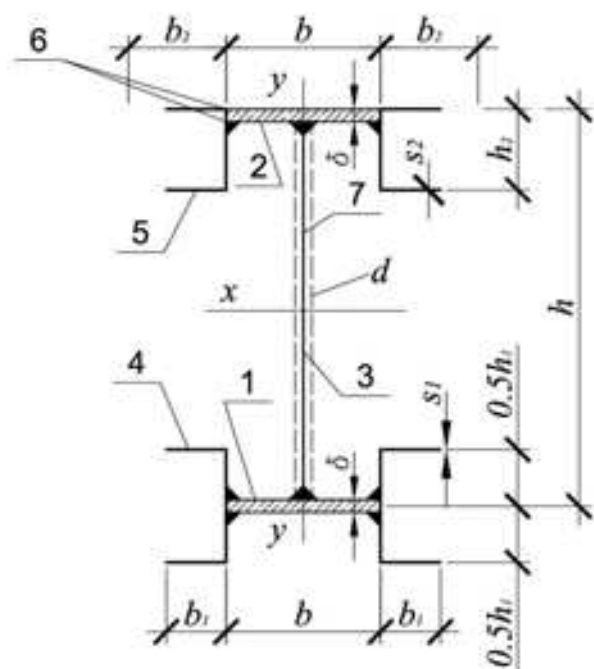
Сварной двутавр стальной балки, полки которого оборудованы гнутыми стальными швеллерами – элементы каркаса термоизоляционного пояса (обогрев поперечного сечения стальной балки с трех граней): 1 – растянутая полка; 2 – сжатая полка; 3 – гофрированная стенка; 4 – швеллеры растянутой полки; 5 – швеллеры сжатой полки; 6 – сварной шов; 7 – антикоррозионное покрытие сварного двутавра;  $h_1 \times b_1 \times s_1$  – высота, ширина и толщина гнутого швеллера, прикрепленного к растянутой полке сварного двутавра стальной балки;  $h_2 \times b_2 \times s_2$  – высота, ширина и толщина гнутого швеллера, прикрепленного к сжатой полке сварного двутавра стальной балки;  $d$  – толщина гофрированной стенки, мм
